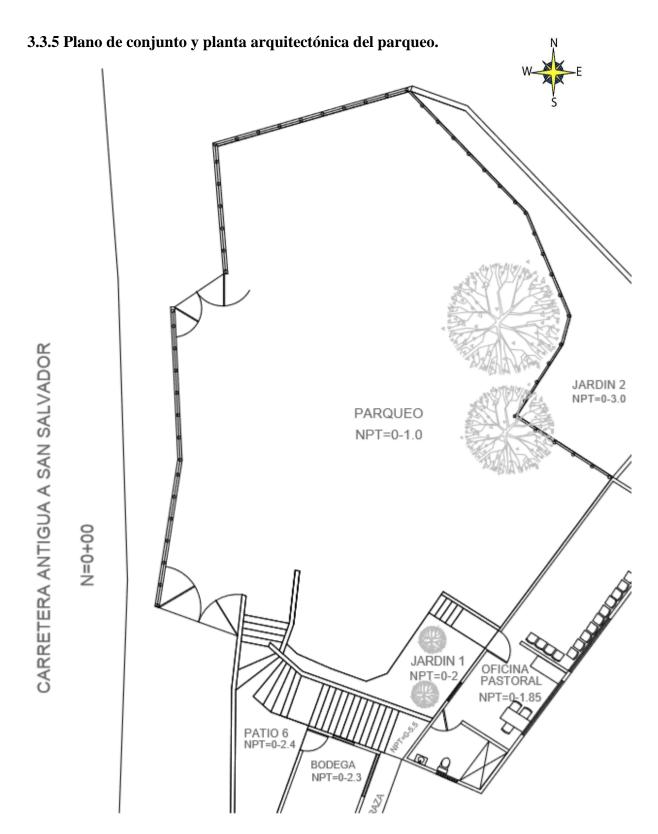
Plano de conjunto y planta arquitectónica del parqueo. Elaboración propia.
